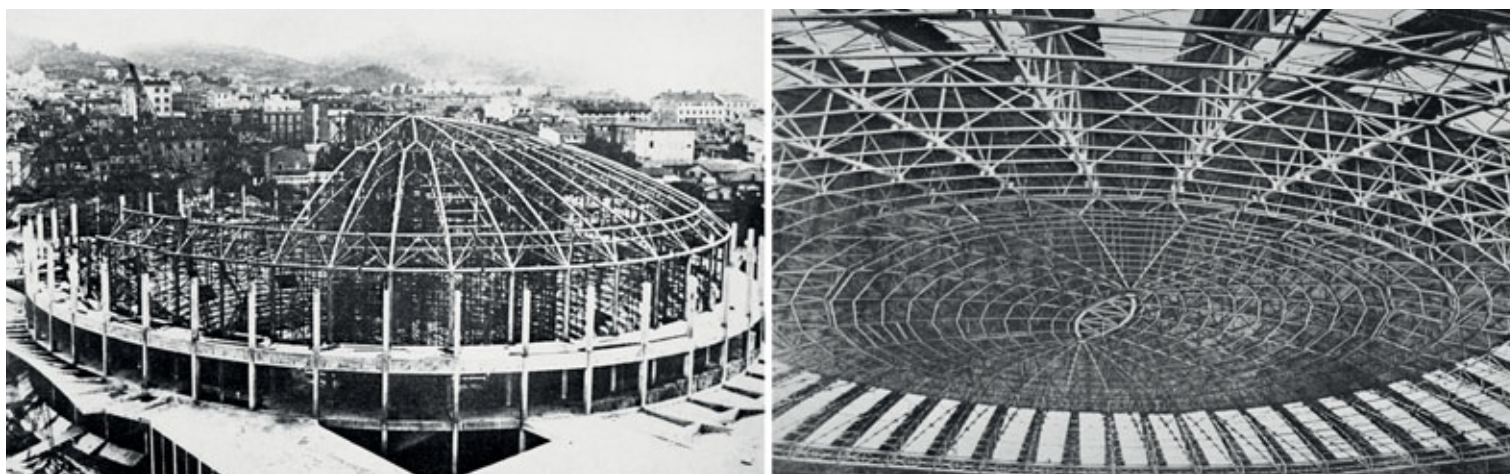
Prima fase operativa del Centro Carpenteria Dalmine (1952-1960): la costruzione della cupola ellittica del Palasport di Bologna, ultimata nel 1956 (Fondazione Dalmine).
